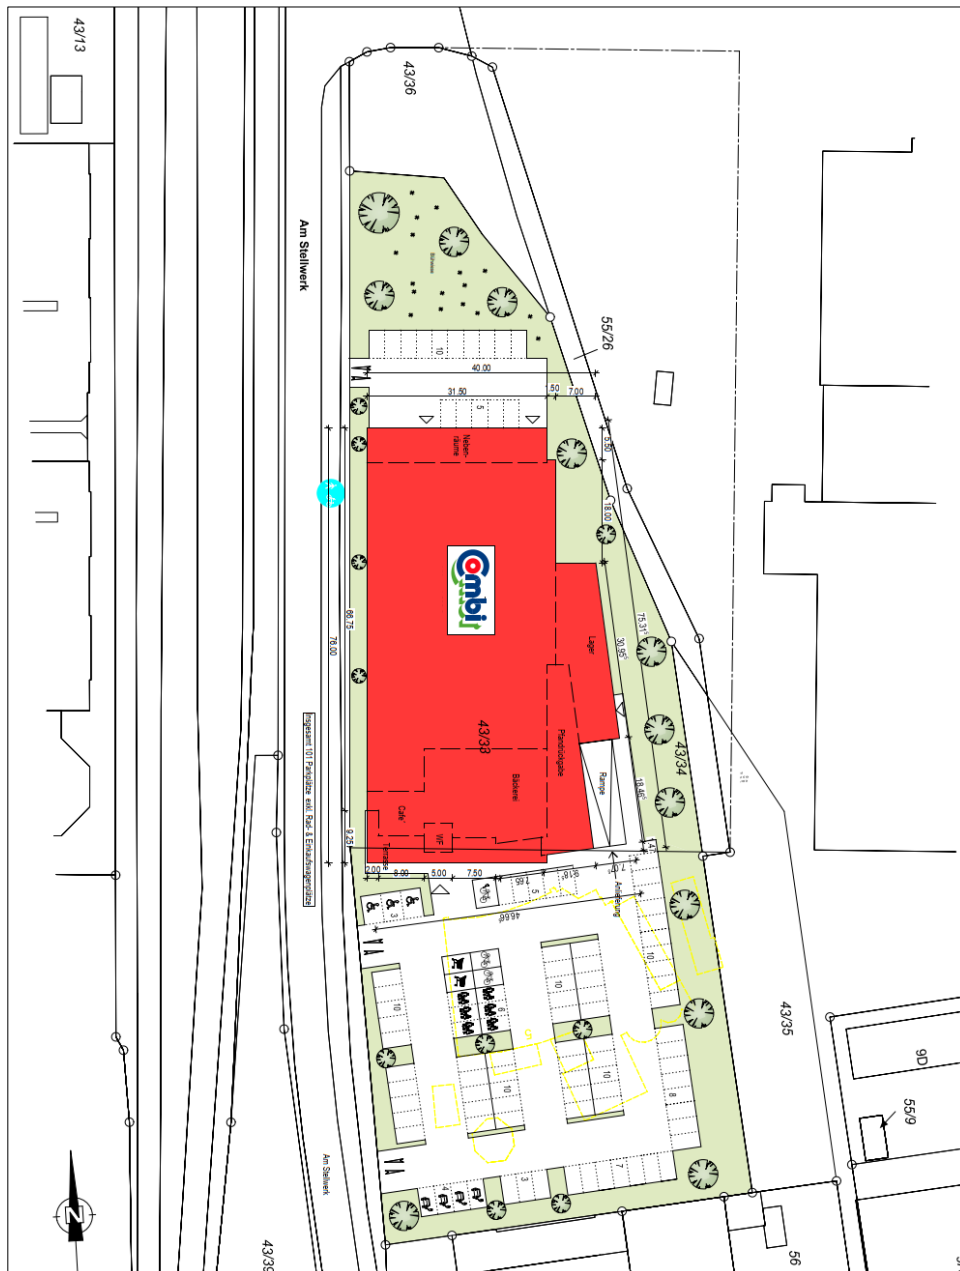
Lageplan mit vorgesehener Aufteilung des Betriebsgrundstücks
